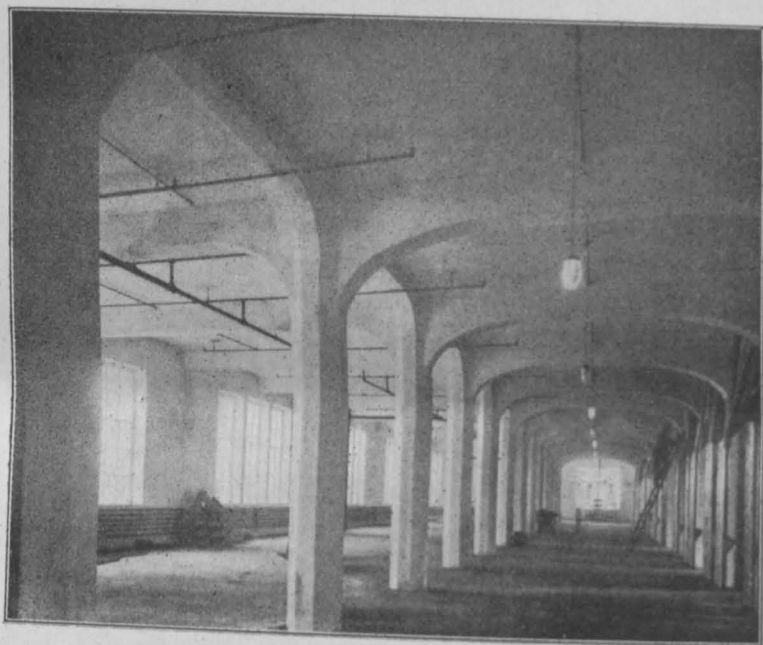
Eisenbeton-Decke in einem Obergeschoß.
